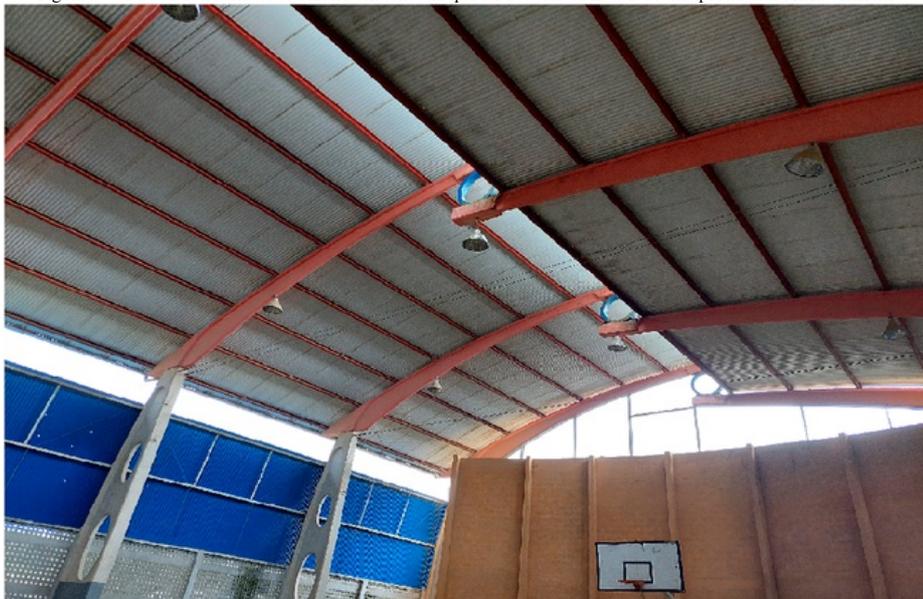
Em destaque: toldo a ser removido e reinstalado. Aos fundos: muro a ser demolido, conforme indicação do Projeto Arquitetônico.
